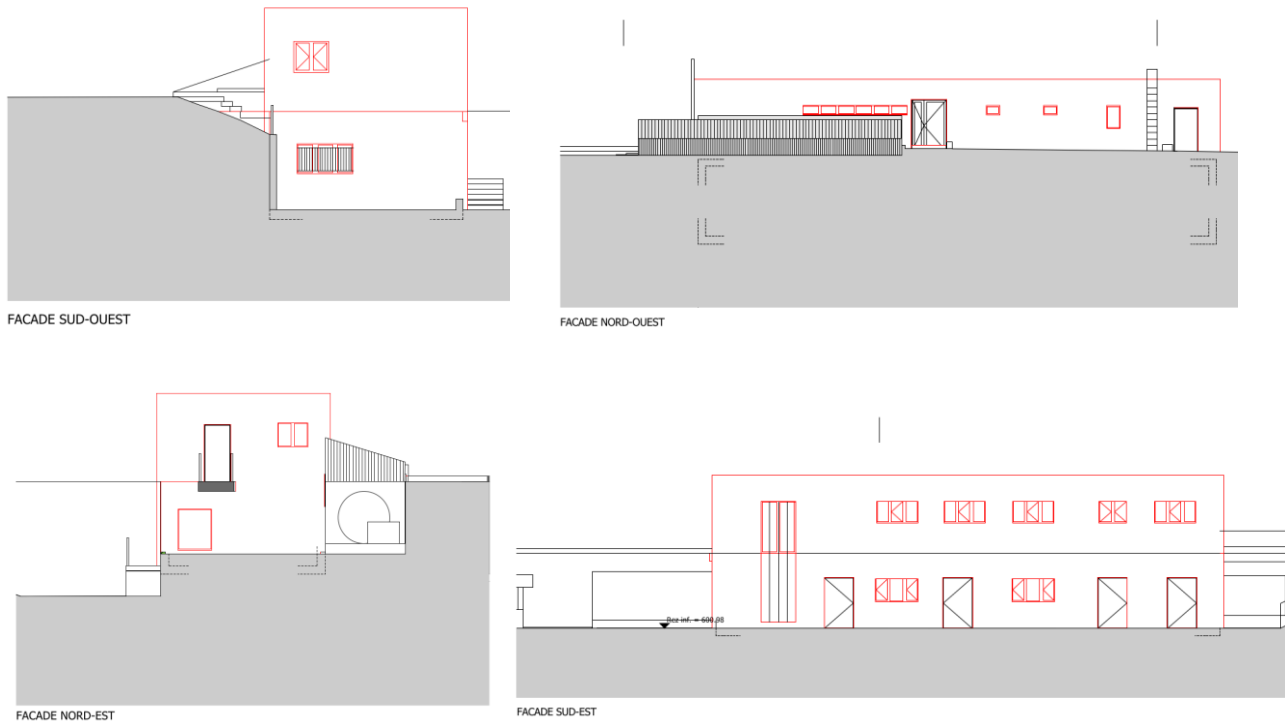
Plan des façades du bâtiment existant au nord-est de la zone de projet. Extrait de [1].
